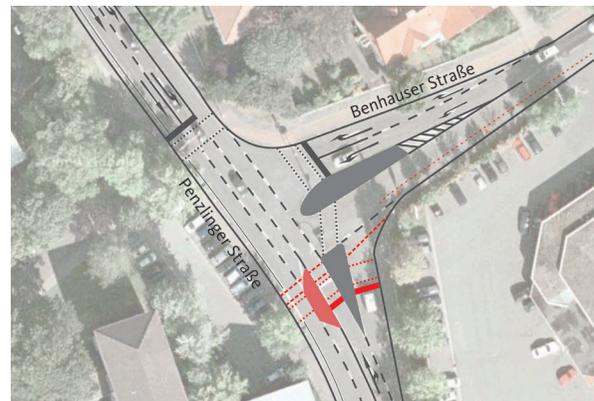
Kreuzung Penzlinger Straße / Benhauser Straße - Entwurfsskizze
